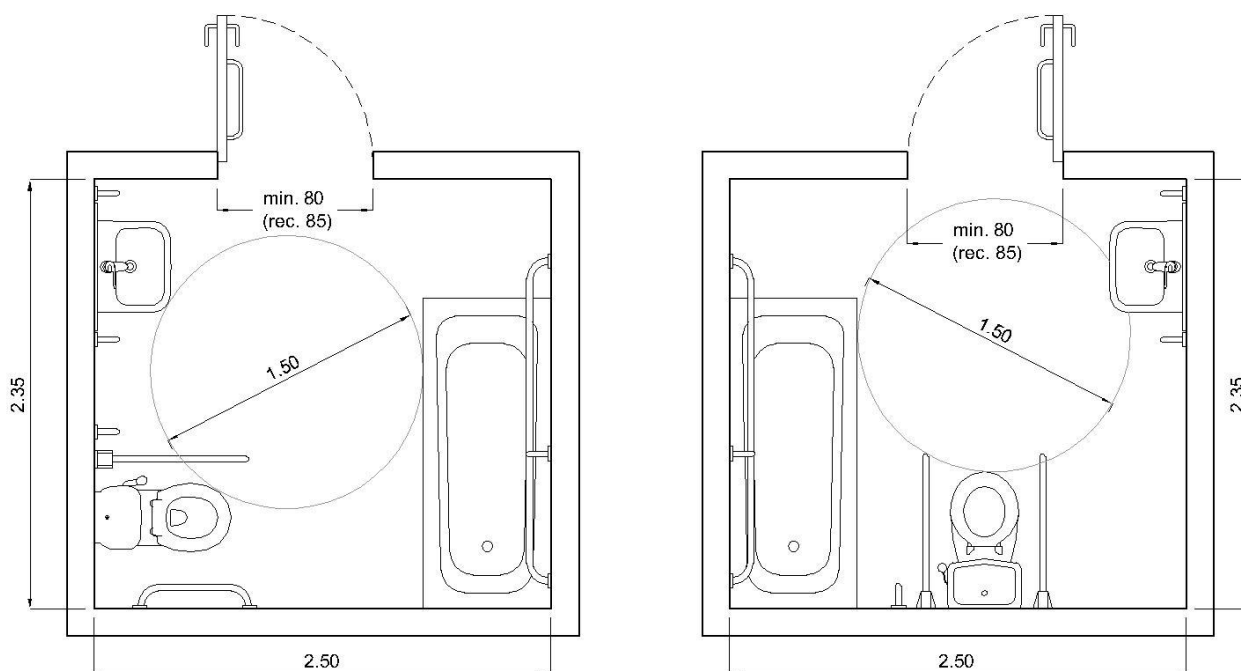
2. – Variante de amenajare a unei băi cu cadă
